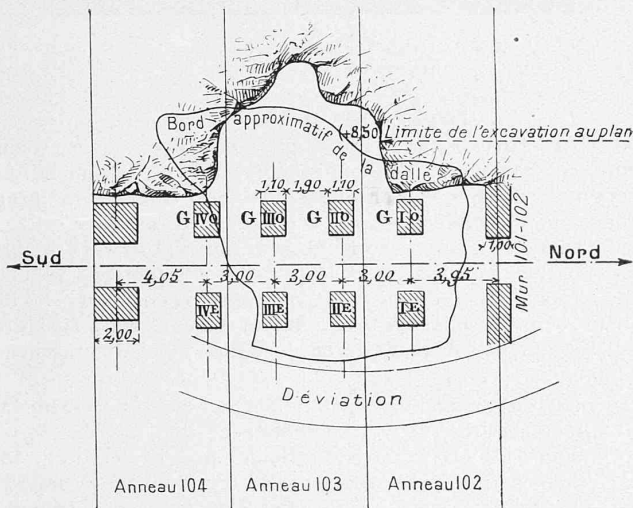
Grundriss auf Kote + 3,50 der Einsturzstelle während der Erstellung des endgültigen Gewölbes.
